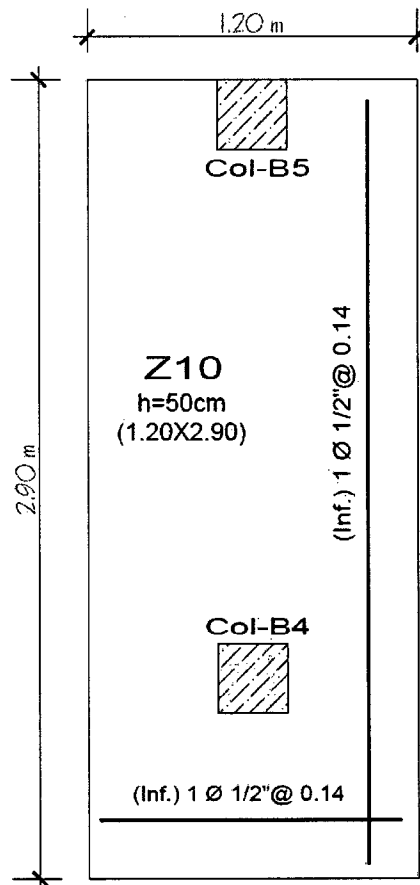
Distribución final del refuerzo para zapata Z-10.
